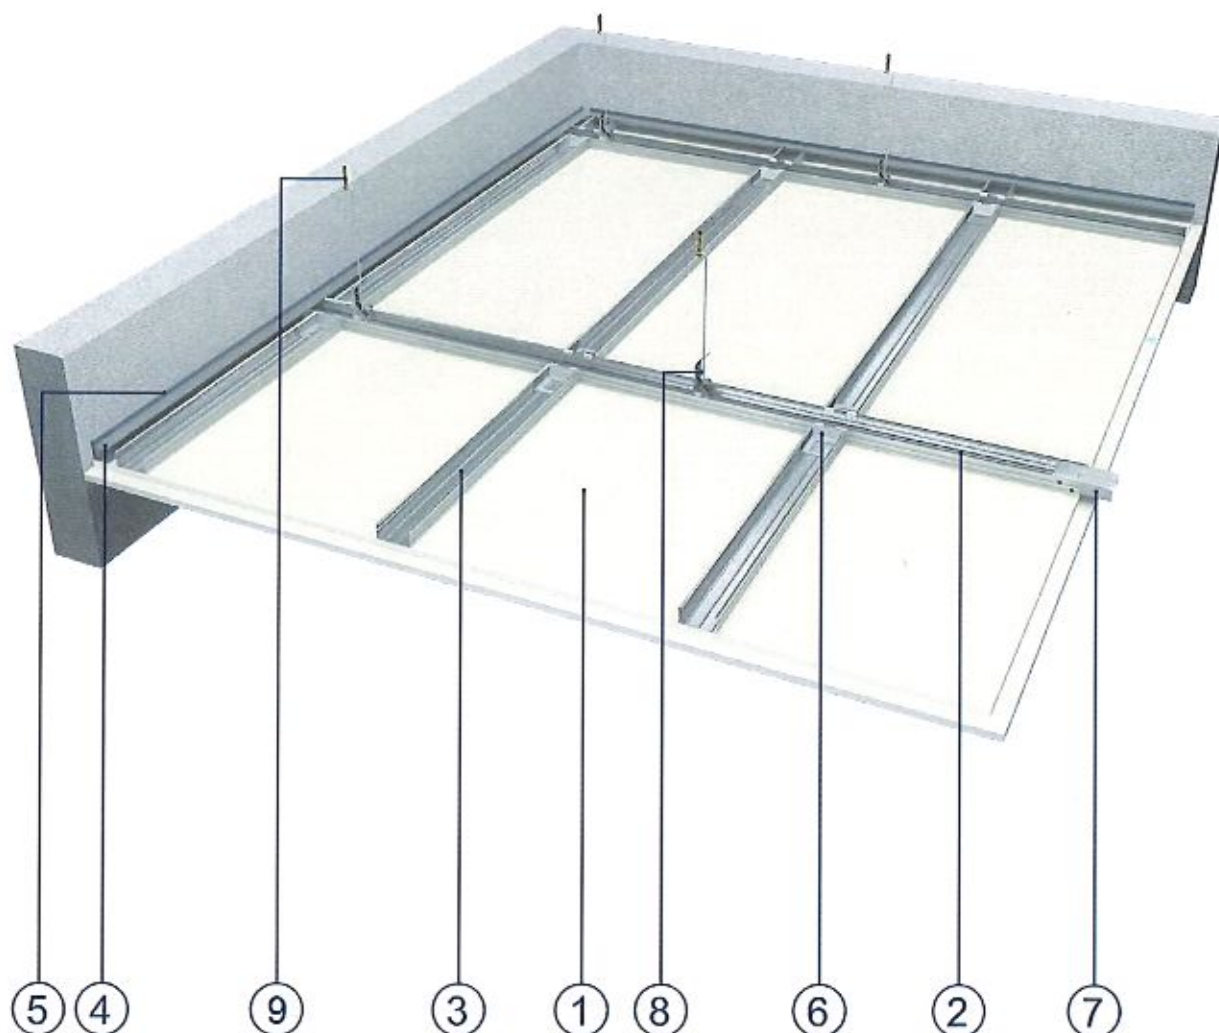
Przekrój poprzeczny sufitu podwieszanego - konstrukcja krzyżowa dwupoziomowa
